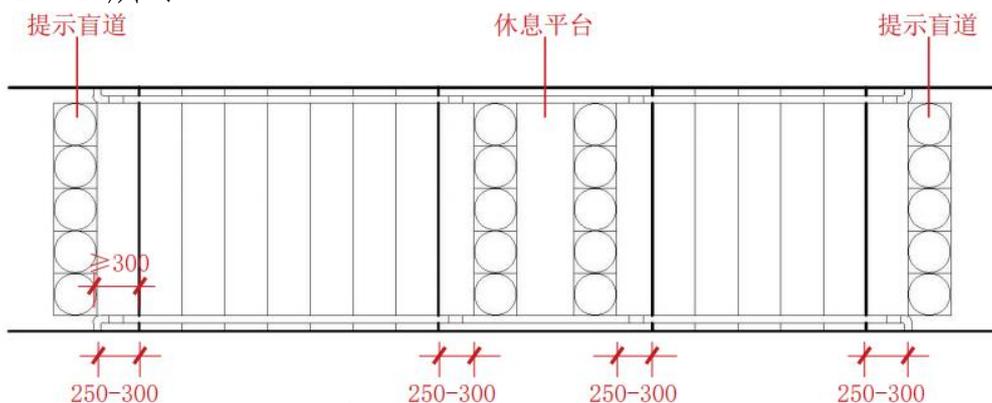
梯段前提示盲道示意图 (单位: mm)
